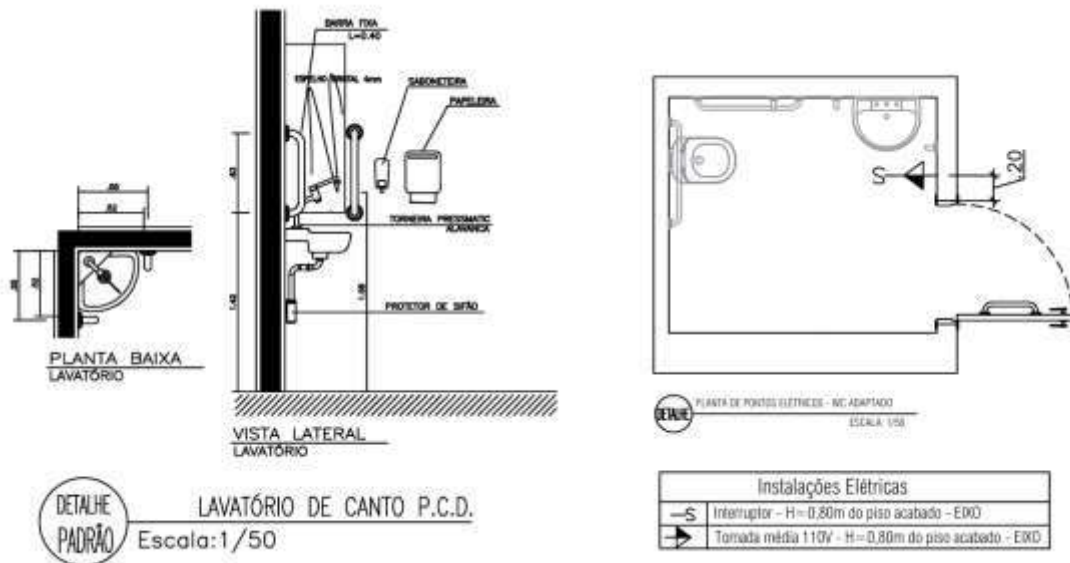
Detalhe de lavatório acessível para banheiro e pontos elétricos (sem escala)
